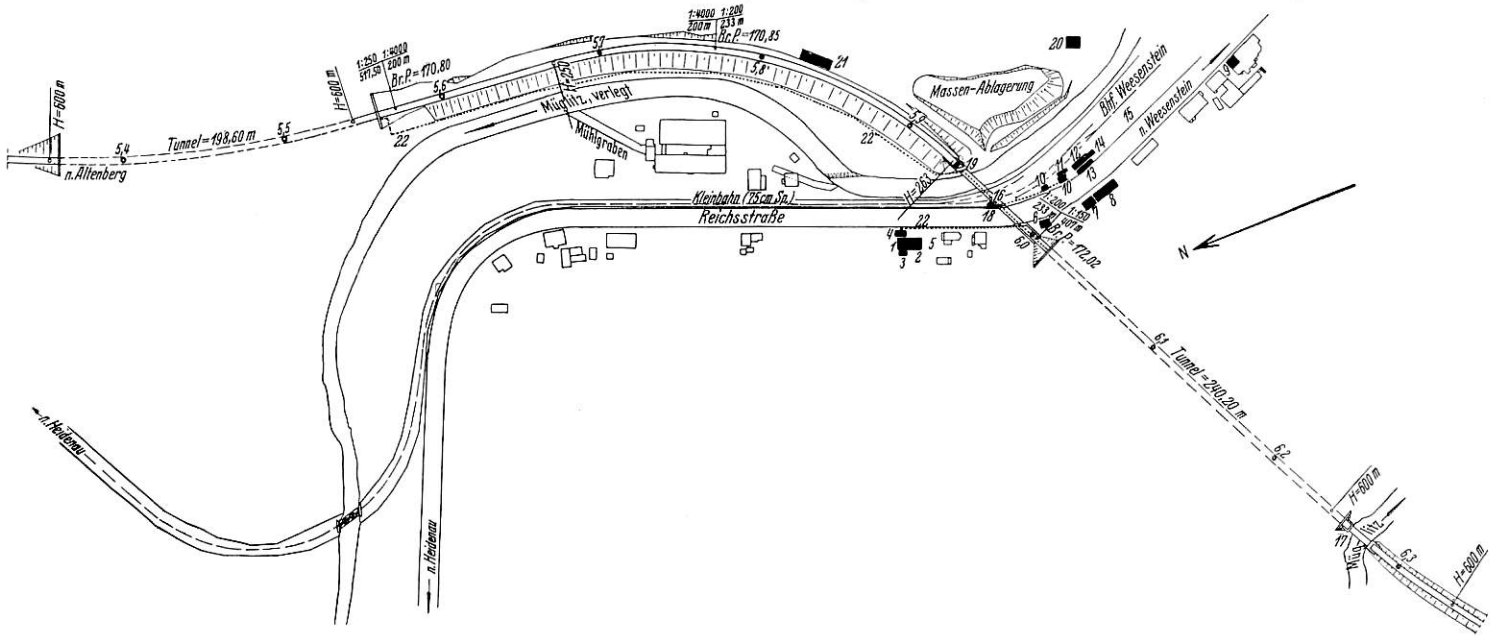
Lageplan mit Baustelleneinrichtung.
